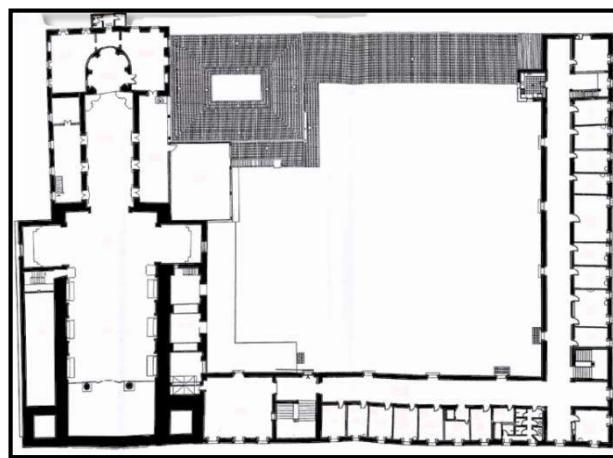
Planta Baixa do segundo pavimento da Basílica Nossa Senhora do Carmo. Fonte: INBMI - IPHAN. 2015.
